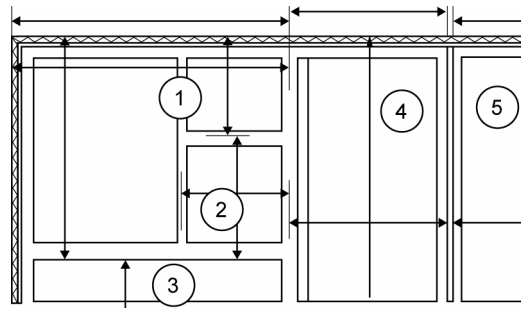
Maßbezüge im Grundriss mit unterschiedlich temperierten Zonen – DIN V 18599 Bild 8. Gilt für nicht Wohngebäude.
